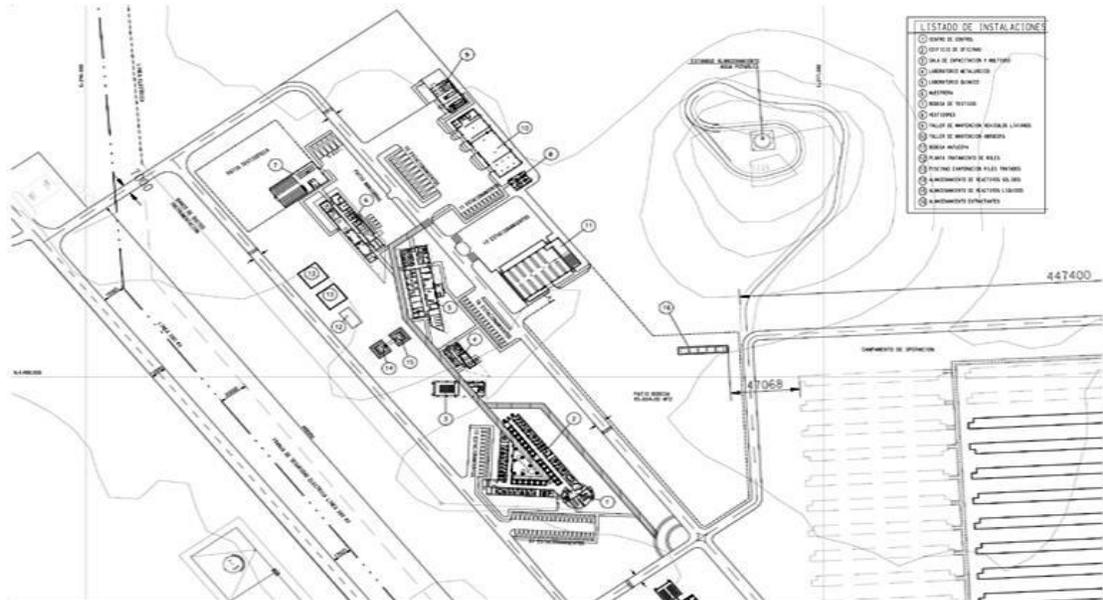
Corresponde al plano de emplazamiento de la obra de Vial y Vives - DSD
